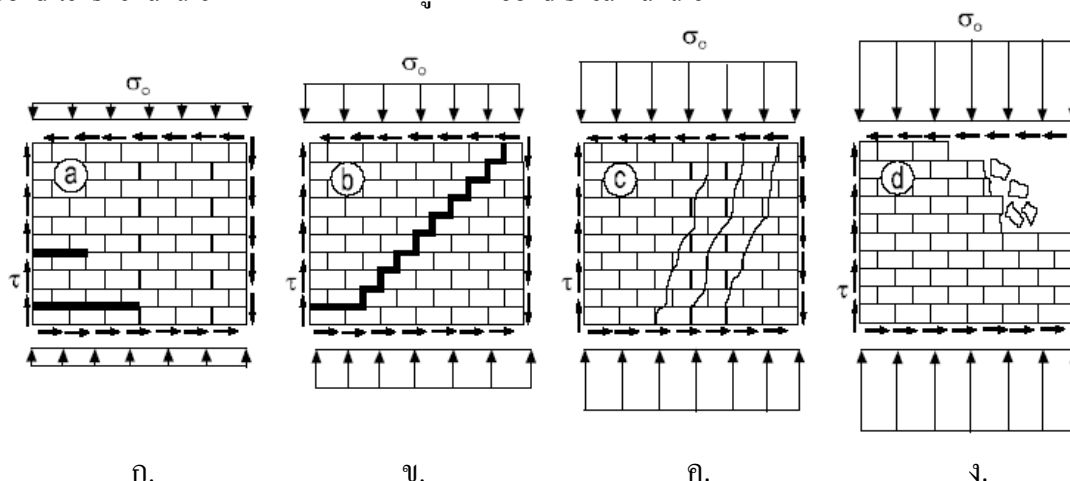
ก. Shear Sliding failure, ข. Diagonal tension shear failure
